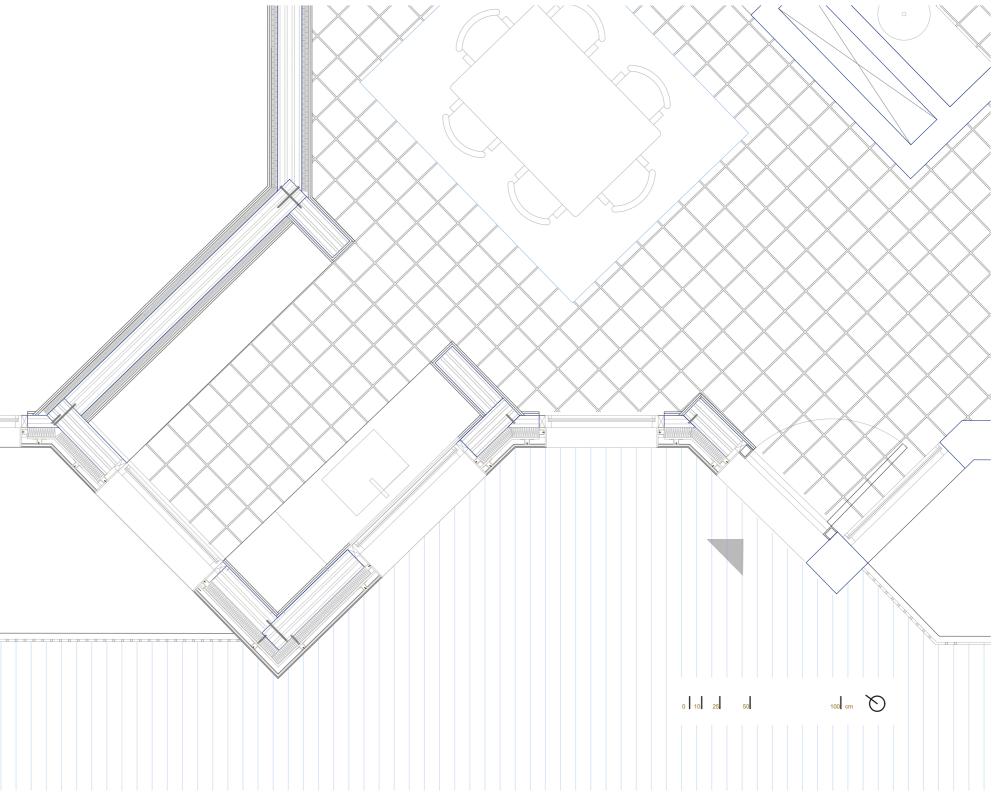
Envolvente de fachadada de corredores. Elaboración propia
